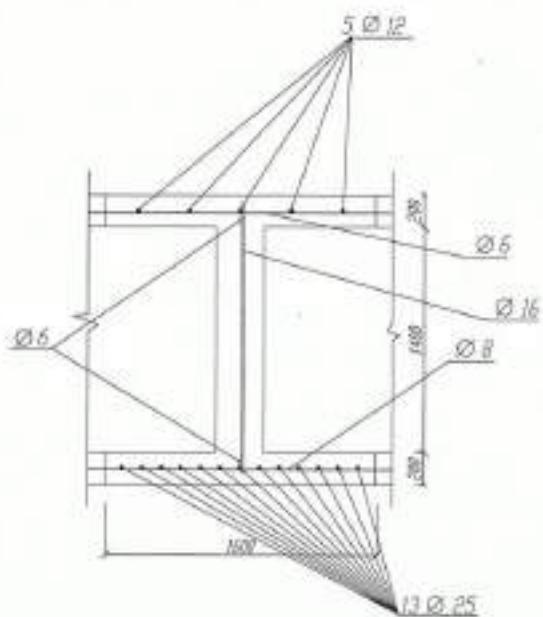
Схема армирования фундамента на участке между осями Г – Ж
